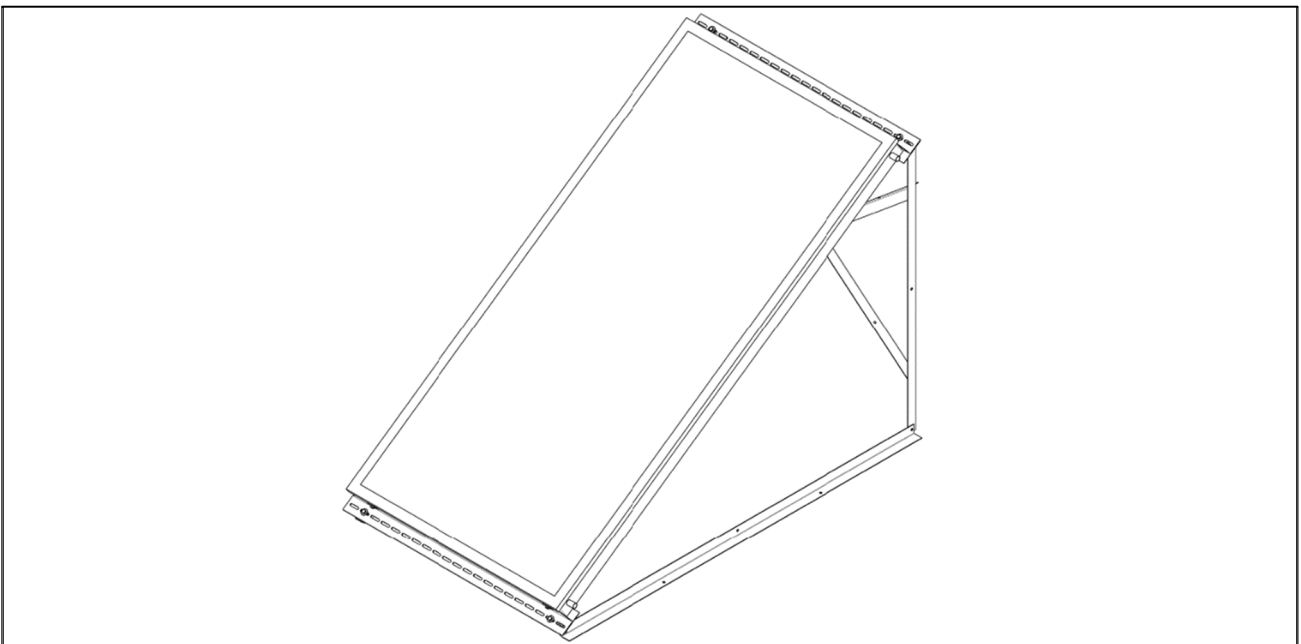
Installazione su tetto piano con inclinazione di 35°
